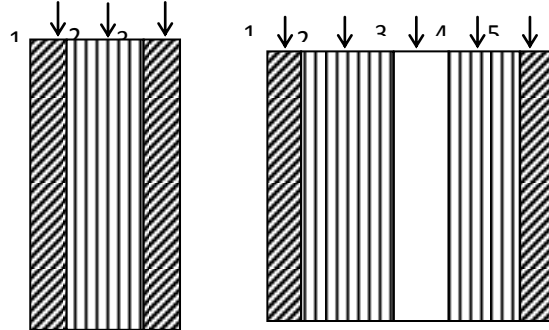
Coupe transversale d'un mur extérieur et intérieur
